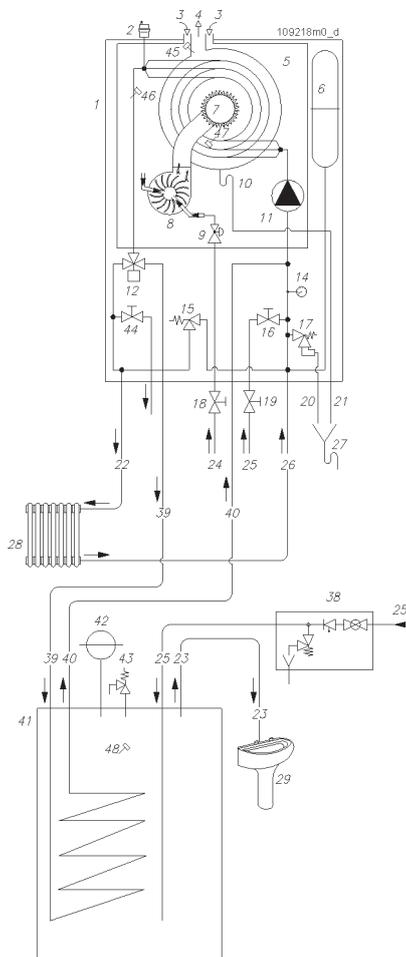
Hydraulikplan Serie WKB mit Untenstehendem Brauchwasserspeicher und Flächenheizung
